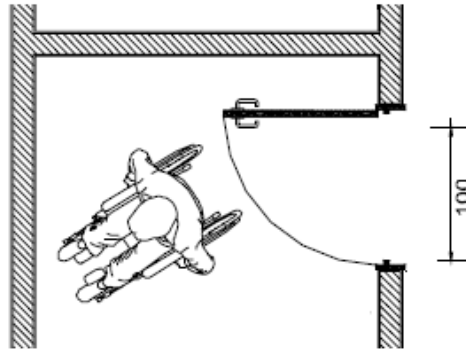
Anchura recomendada de las puertas de la vivienda (medidas en centímetros)
